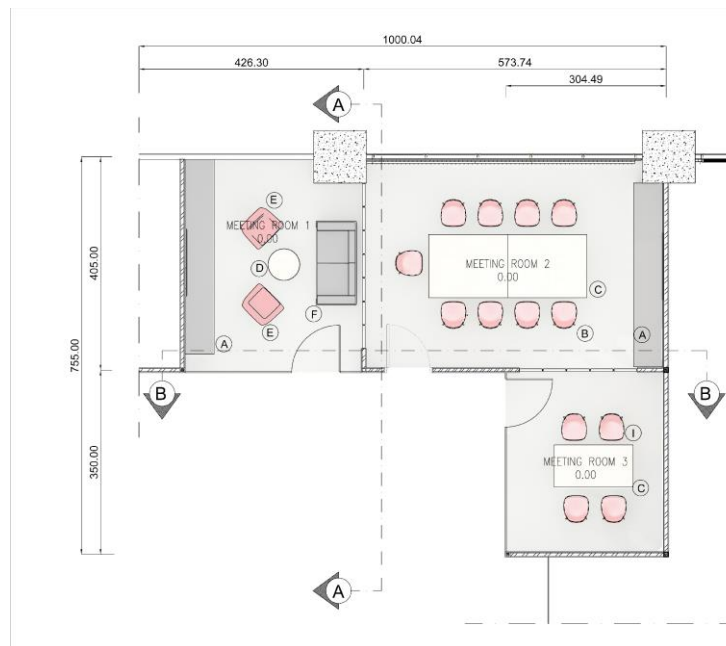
Detail Furniture & Elemen Estetis pada Ruang Terpilih 1
